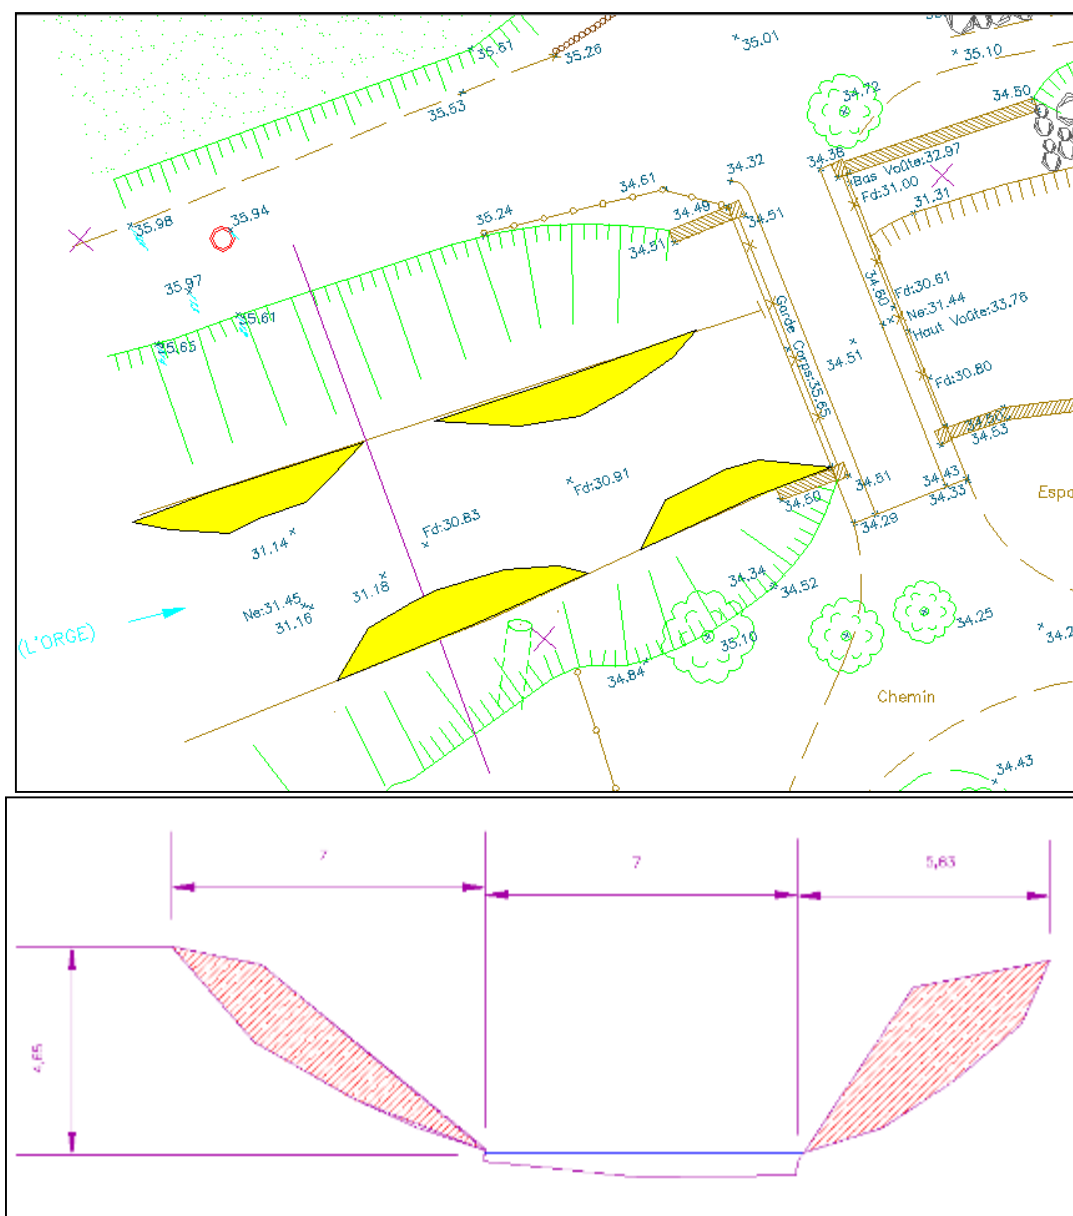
Plan de masse et profil en travers : état projet (en hachuré rouge : la partie à décaisser).
